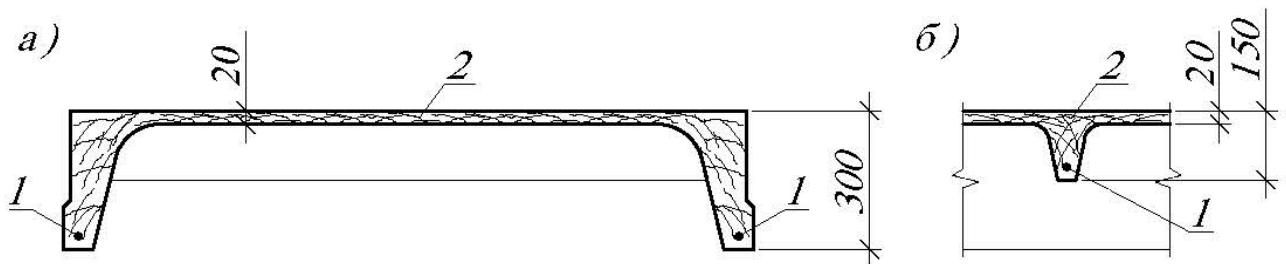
Условное армирование ребристой сталефибробетонной плиты перекрытия: а – поперечное ребро плиты; б – продольное ребро плиты; 1 – продольная арматура; 2 – стальное волокно.
